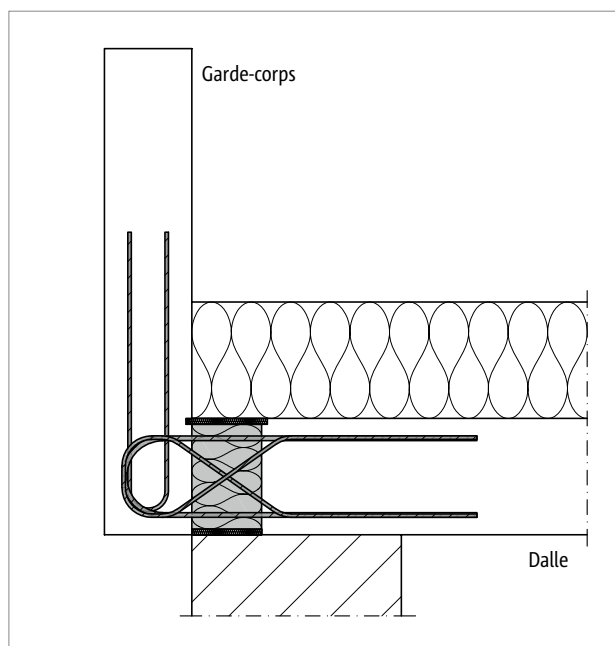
Schöck Isokorb® T Type F : Raccordement d'un garde-corps avancé avec maçonnerie isolante
